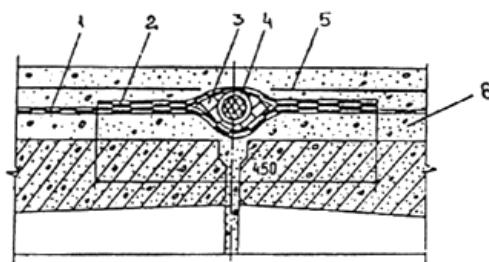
Конструкция гидроизоляции деформационного шва между плитами перекрытия:
